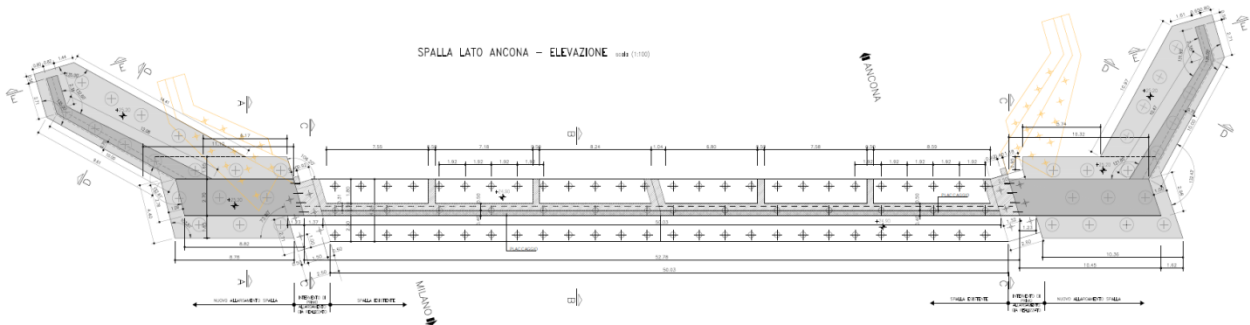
Spalla lato Ancona - Elevazione
